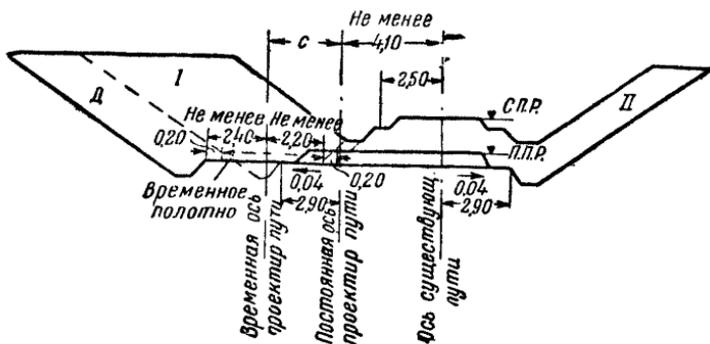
Поперечный профиль разработки выемки для второго пути без смещения оси пути
